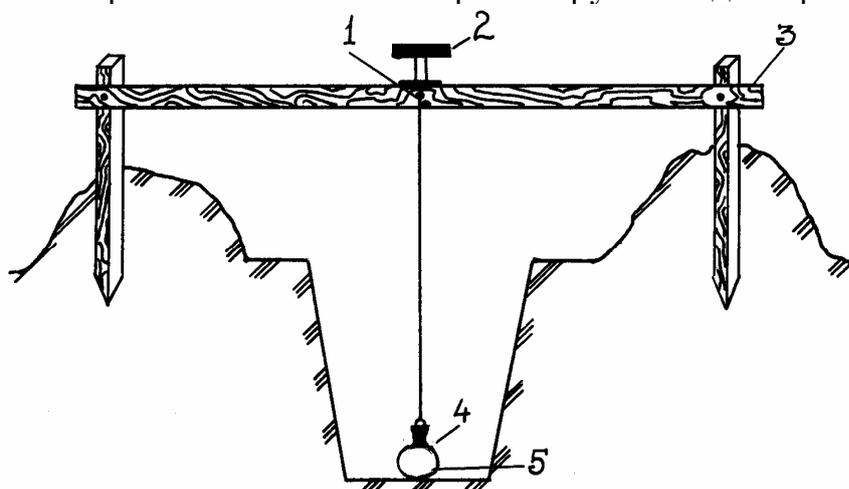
Схема проектирования оси трубопровода на дно траншеи:
